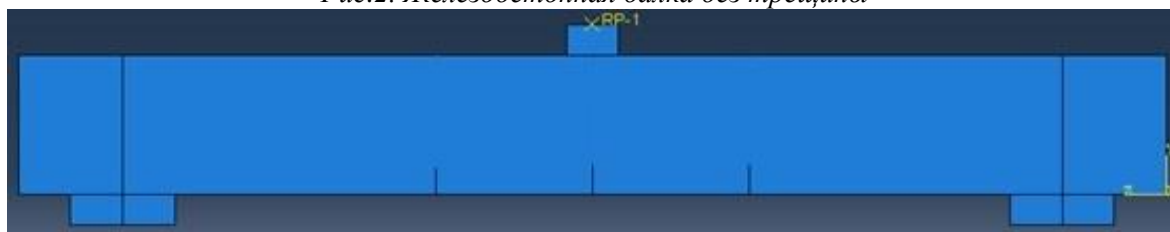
Железобетонная балка с 3-мя начальными организованными трещинами
